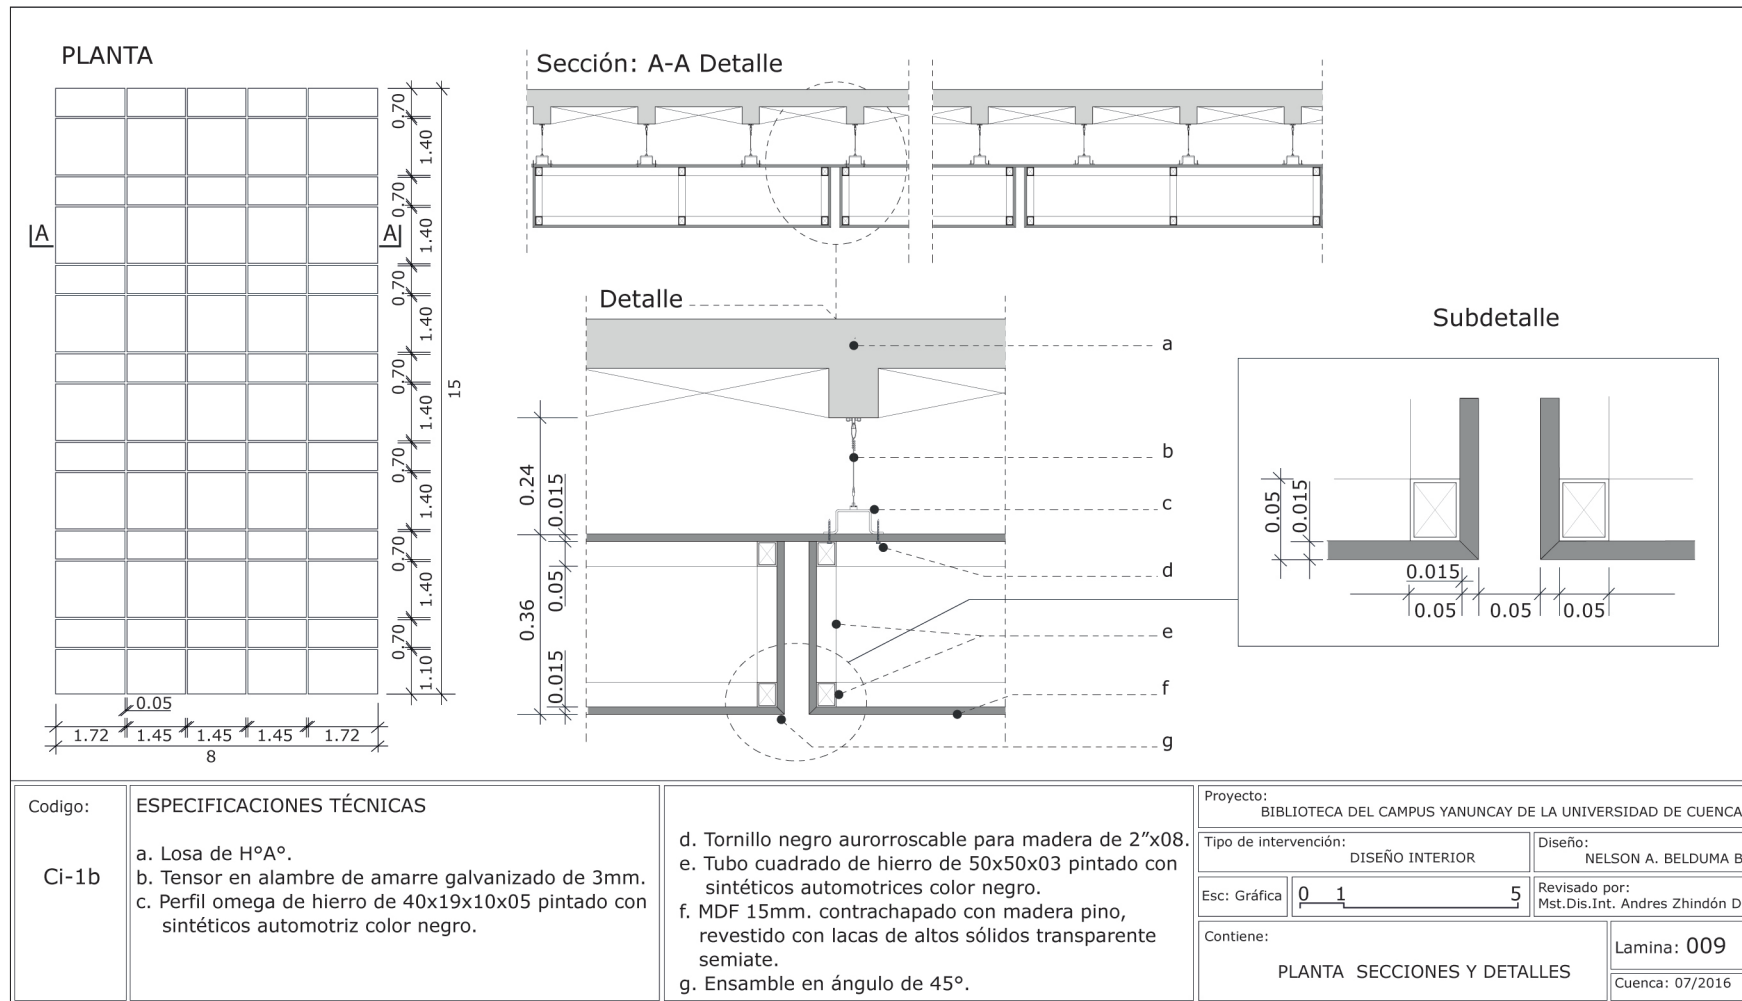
Planta, secciones y detalles. Estanterías. Ci-1b.
